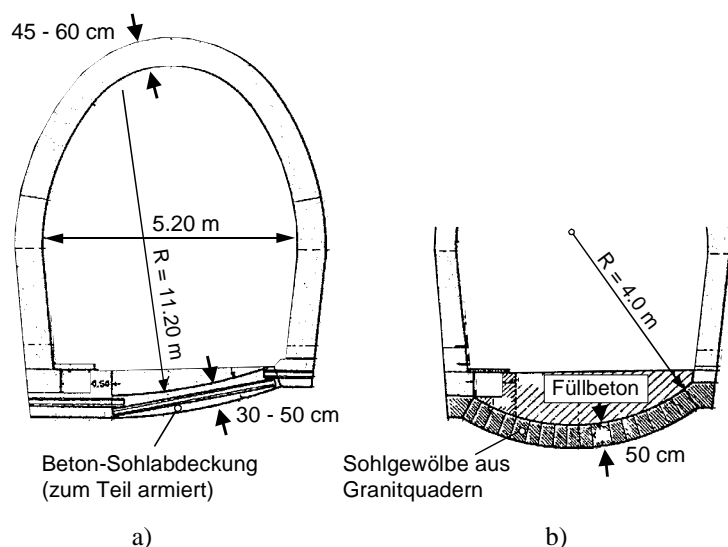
Rekonstruktion des Grenchenbergtunnels in einem Tunnelabschnitt im Opalinuston
